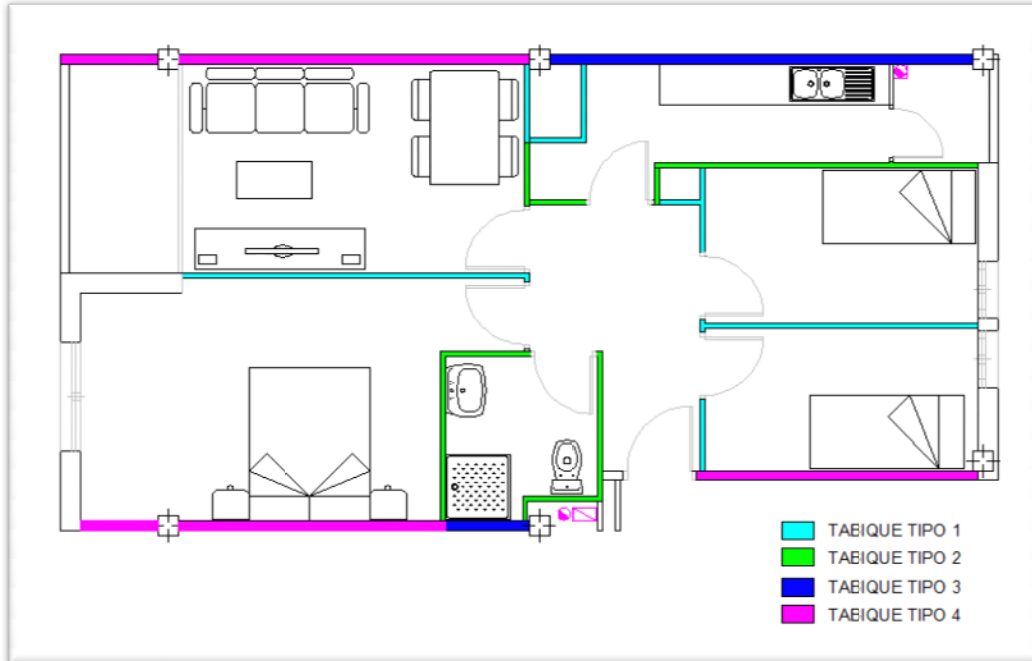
Tipos de tabiquería en la vivienda en estado actual.
